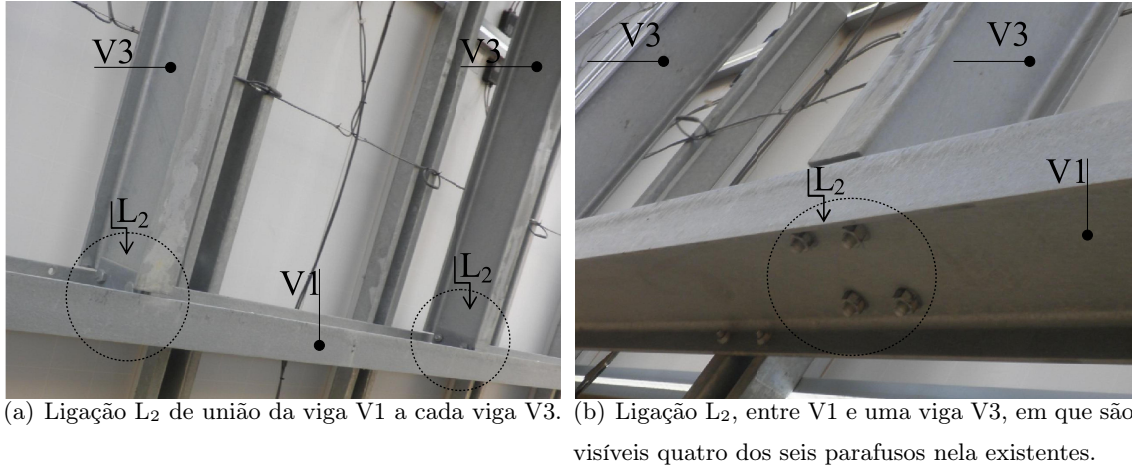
Ligação L_2 entre as vigas V1 e V3.
